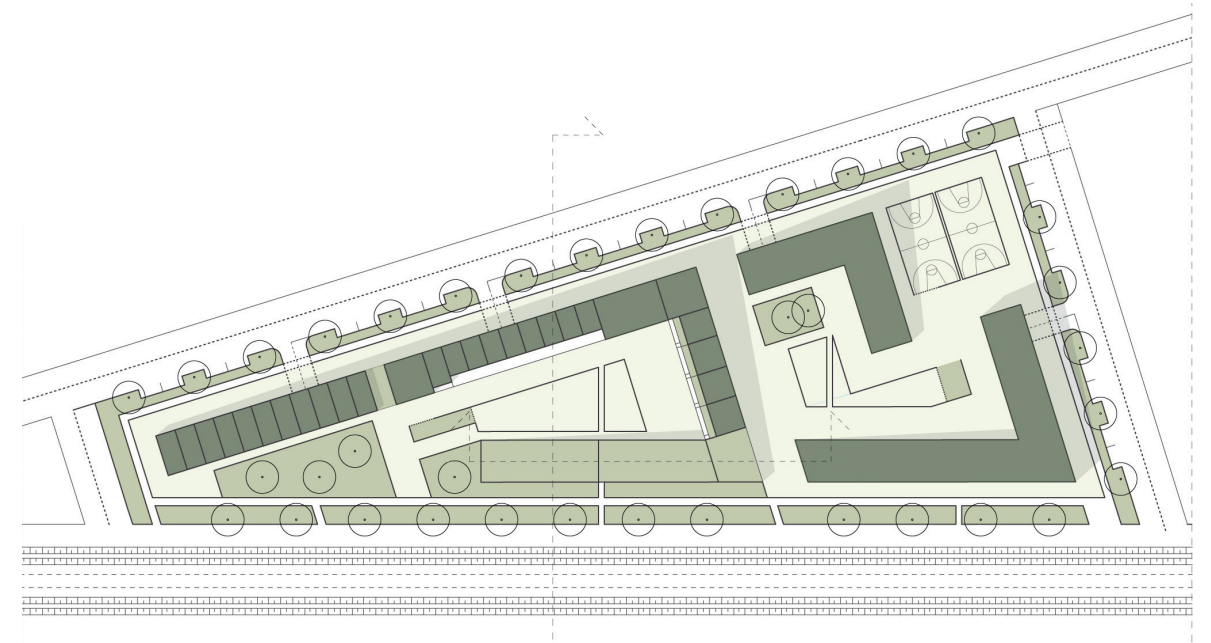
Lageplan: neues Quartier mit Wohnungen und Gewerberäumen
